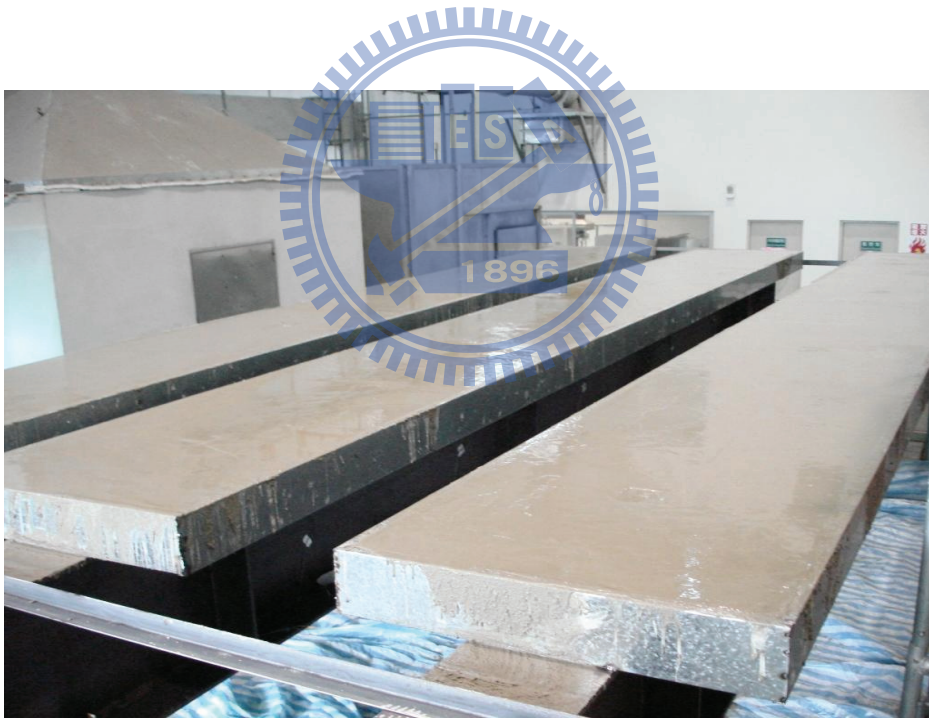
試體樓板混凝土施工完成 (趙文成與陳誠直 2009)
